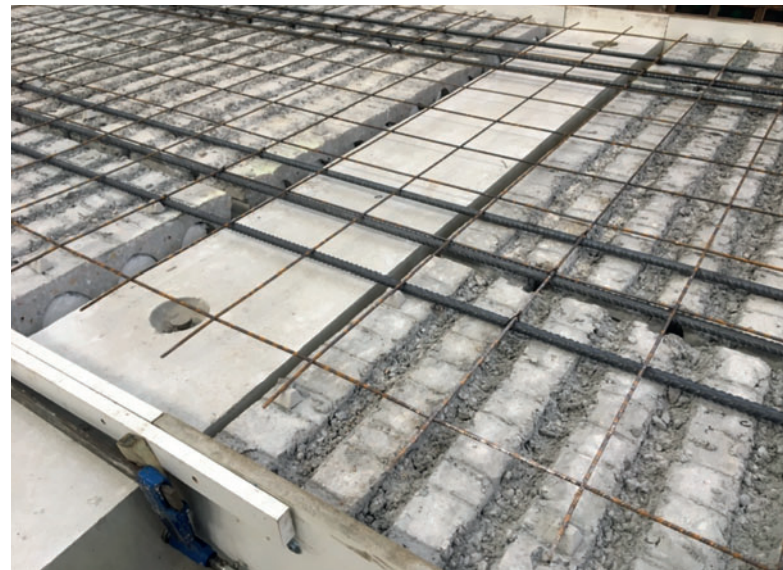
Grooved Hollowcore System vor dem Einbringen des Aufbetons. Wichtige Details: Bewehrungsstäbe werden direkt auf die Decke gelegt und in geeigneter Weise vom Auflager getrennt, damit der Beton den verbleibenden Spalt ausfüllt und das negative Biegemoment übertragen werden kann; eventuell werden Verschlusskappen benötigt, damit die Hohlräume der Spannbetonfertigdecken nicht mit Beton volllaufen.
